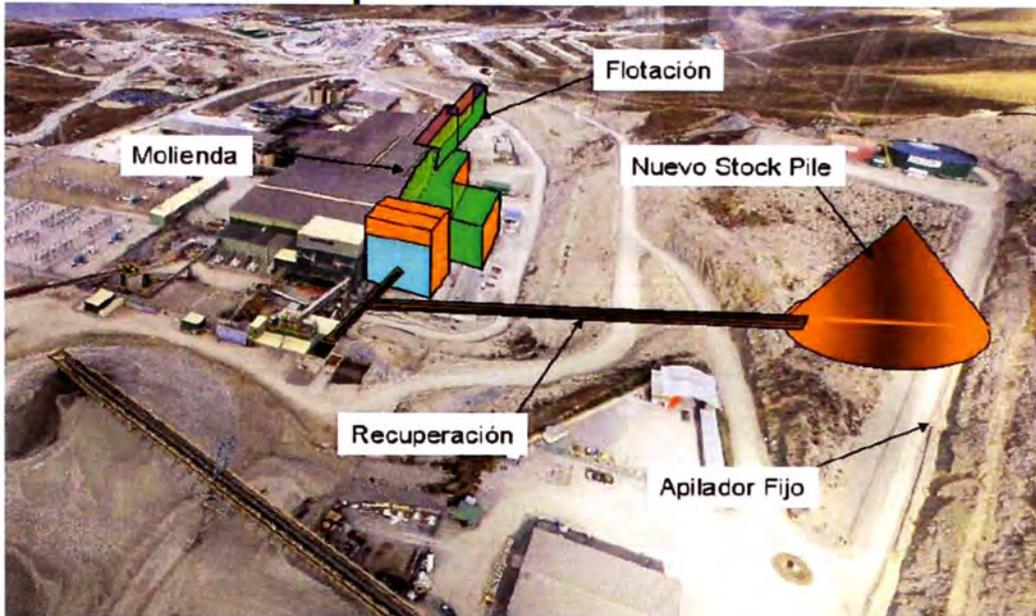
Vista tridimensional de las nuevas estructuras. (Fuente: Ingeniería & Proyectos Antamina)
